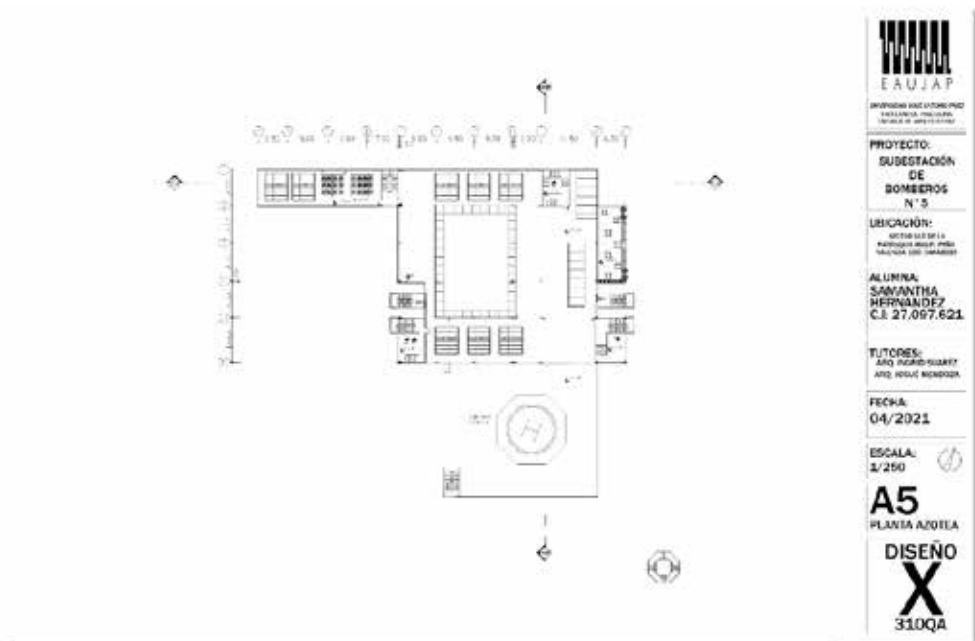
Planta Azotea A5. Fuente: La Autora (2021)
